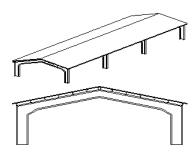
Nave industrial de marco rígido con sección transversal constante
